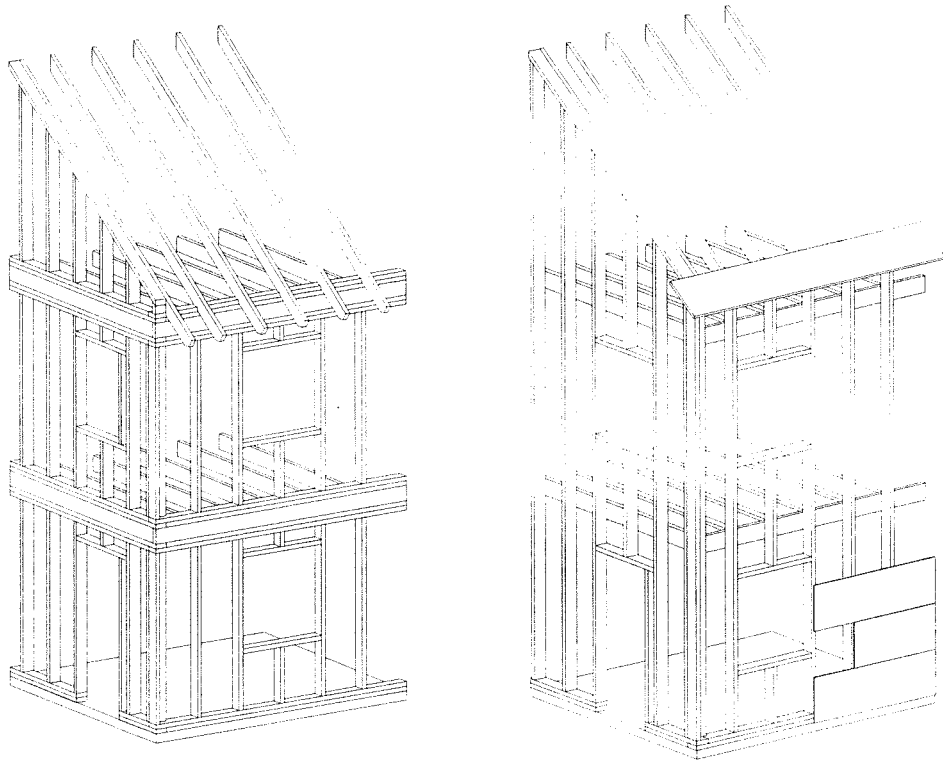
Prinzipdarstellung einer Gebäudeecke mit Dachkonstruktion für ein zweigeschossiges Gebäude in Holzrahmenbauweise (links: Stockwerkbauweise, rechts: Balloon-Framing)
